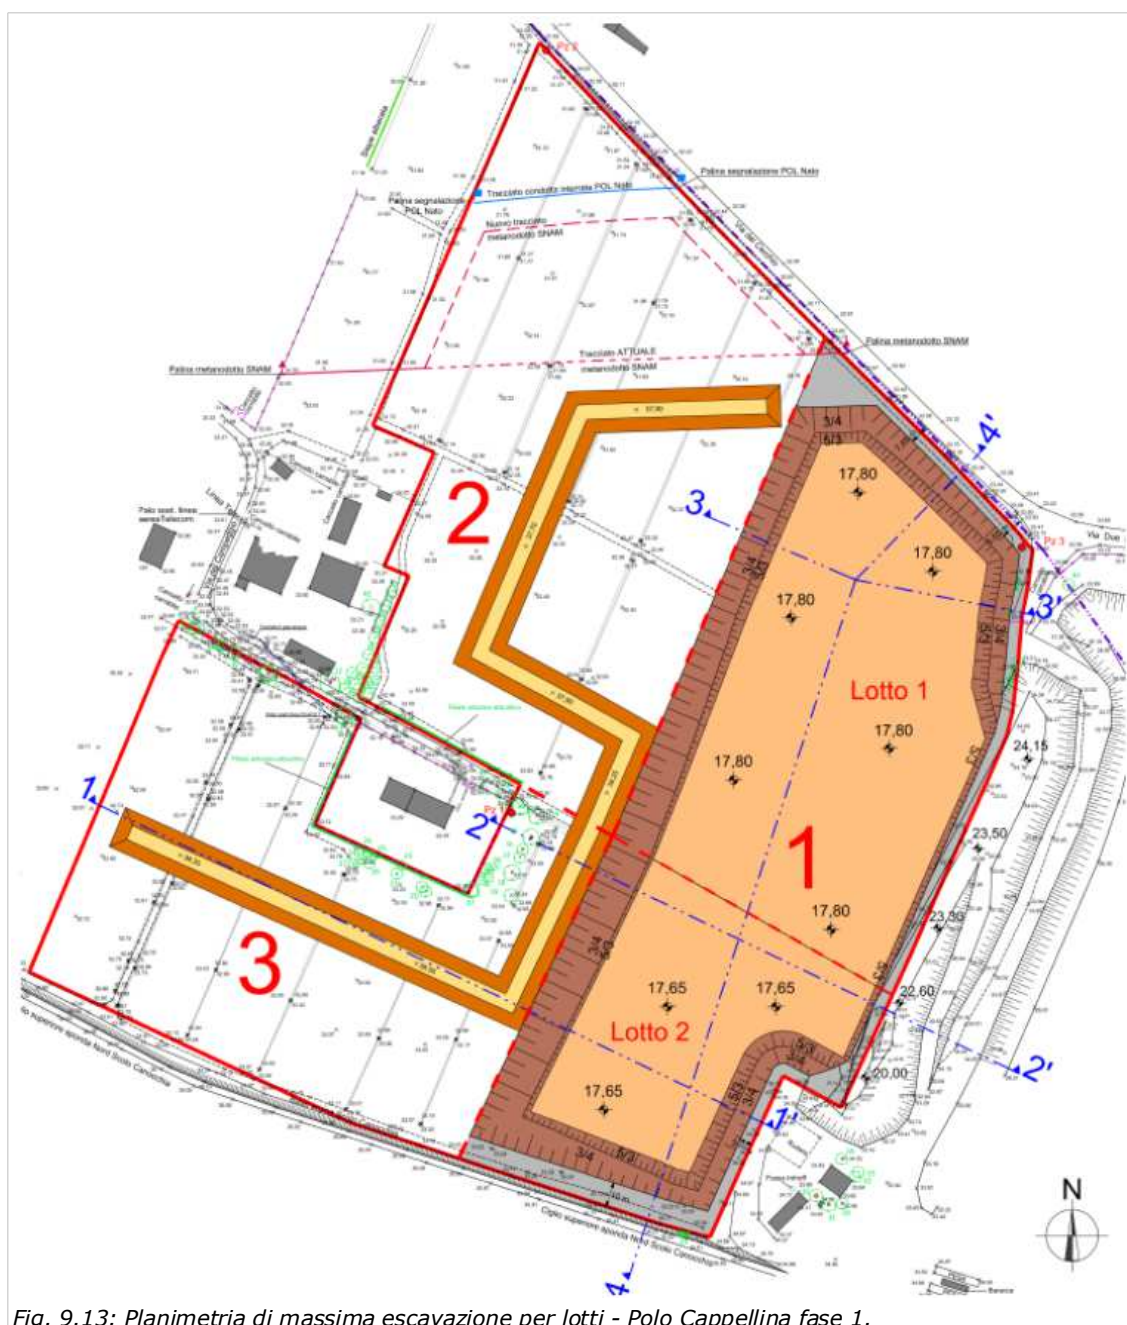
Planimetria di massima escavazione per lotti - Polo Cappellina fase 1.
